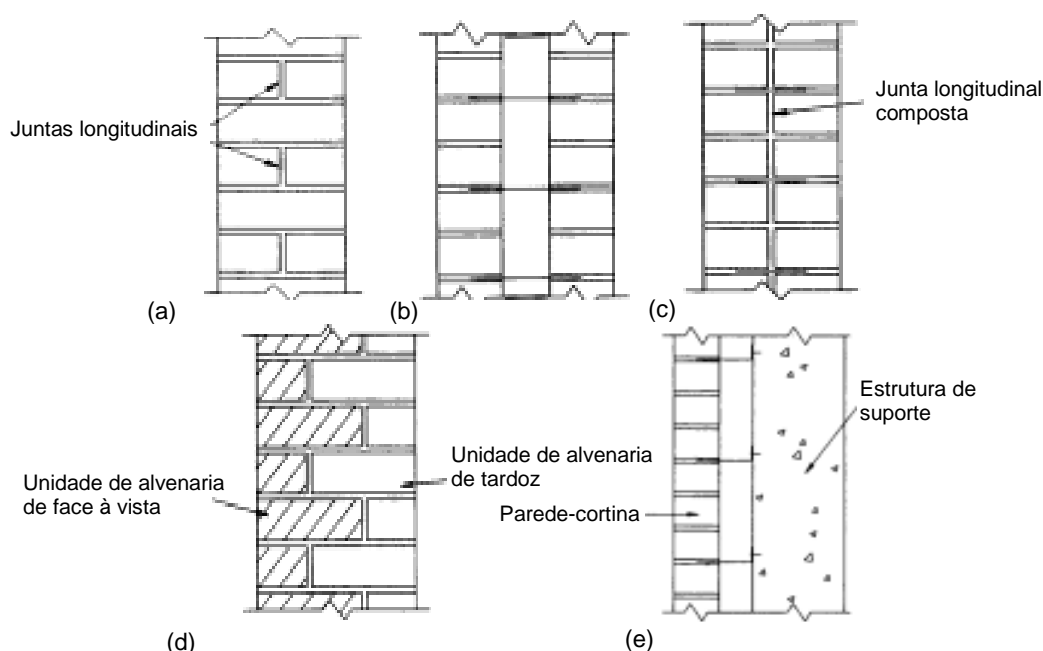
Tipos de parede em função do tipo de aparelho: (a) parede simples; (b) parede dupla; (c) parede composta; (d) parede de face à vista; (e) parede-cortina. [7]
